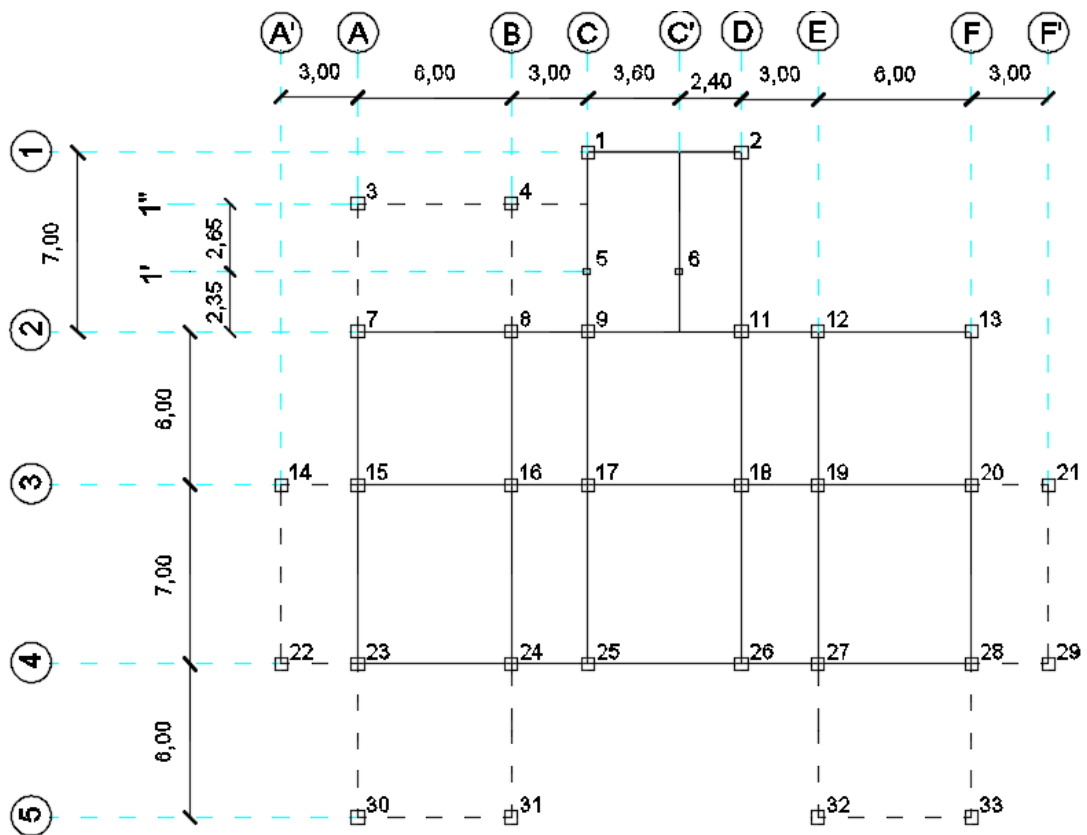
, Esquema de Planta de cimentación edificio Bco. Central, línea entrecortada negra representa cadenas, unidad de medida (m).
